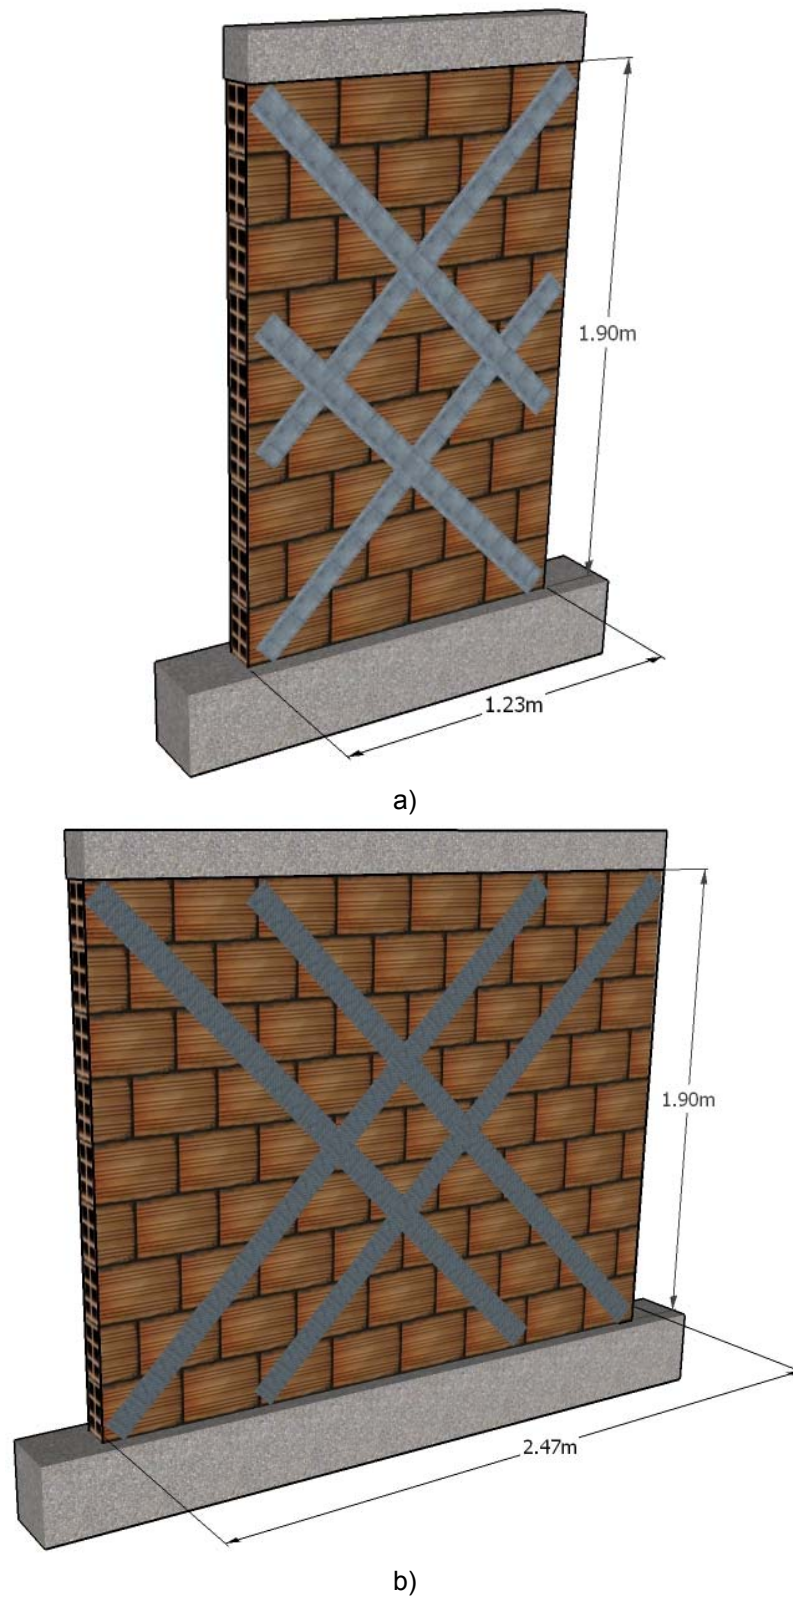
Modelado 3D del reforzamiento en diagonal
